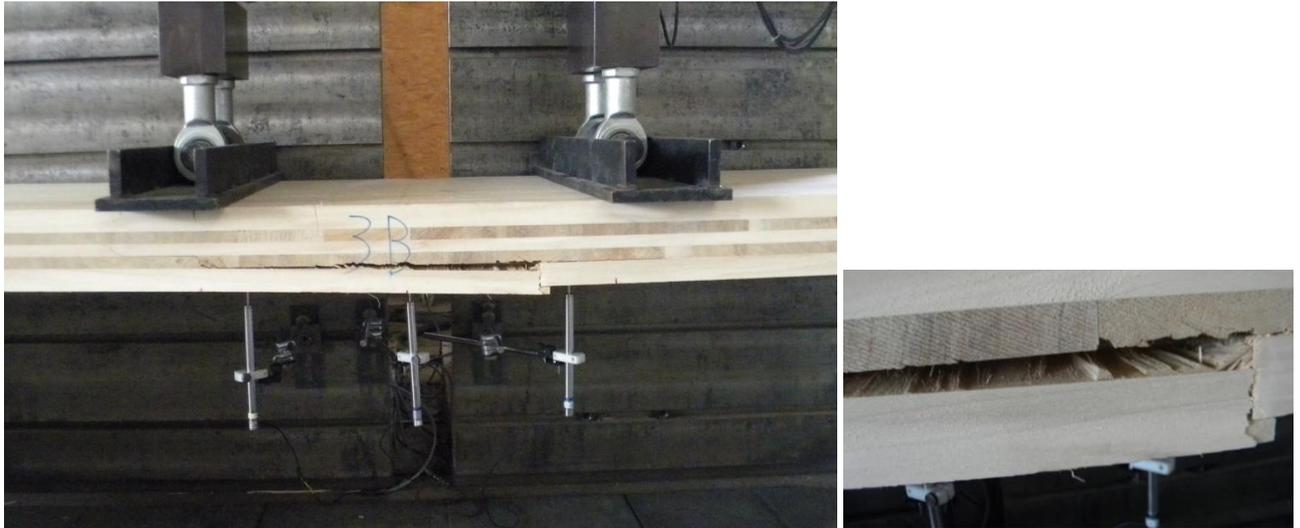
rupture d'un aboutage lors d'un essai de flexion 4 points selon la norme EN 16351 sur panneau CLT en grandeur d'emploi
